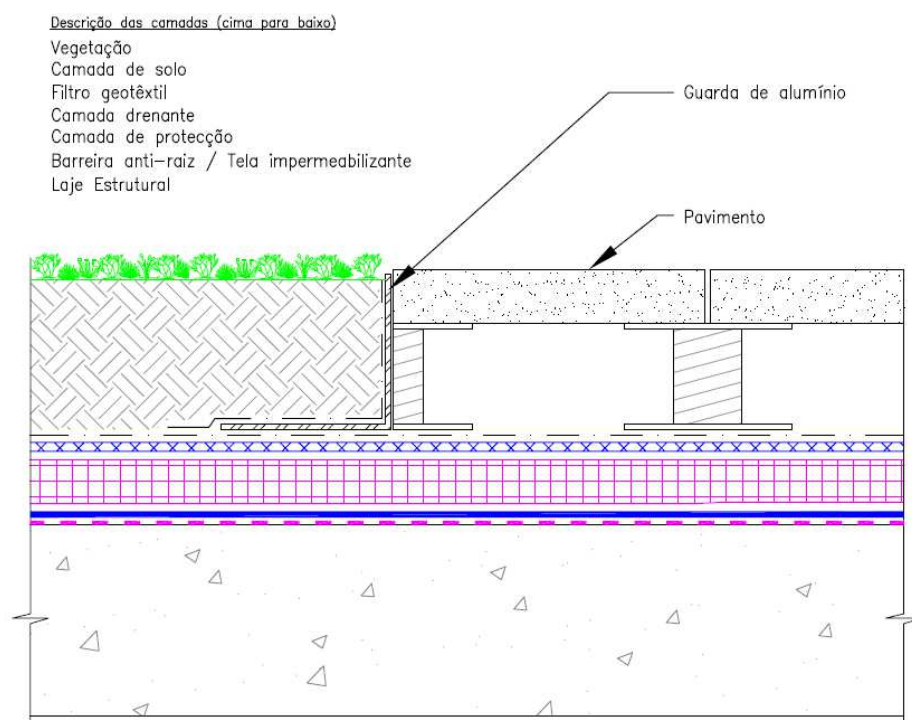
Pormenor de transição de pavimento para cobertura jardim, [30].
